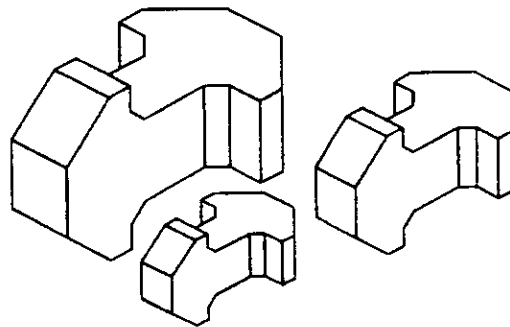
Toscanos modificados por la CSU para la protección de pilas y estribos de puente.
